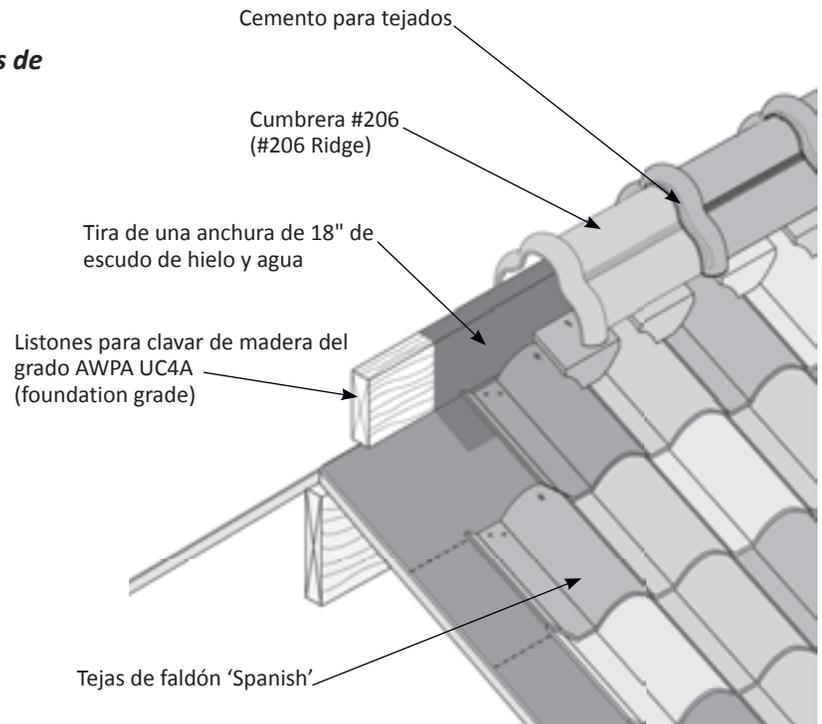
Detalle de cumbrera #206 (#206 Ridge Detail)
